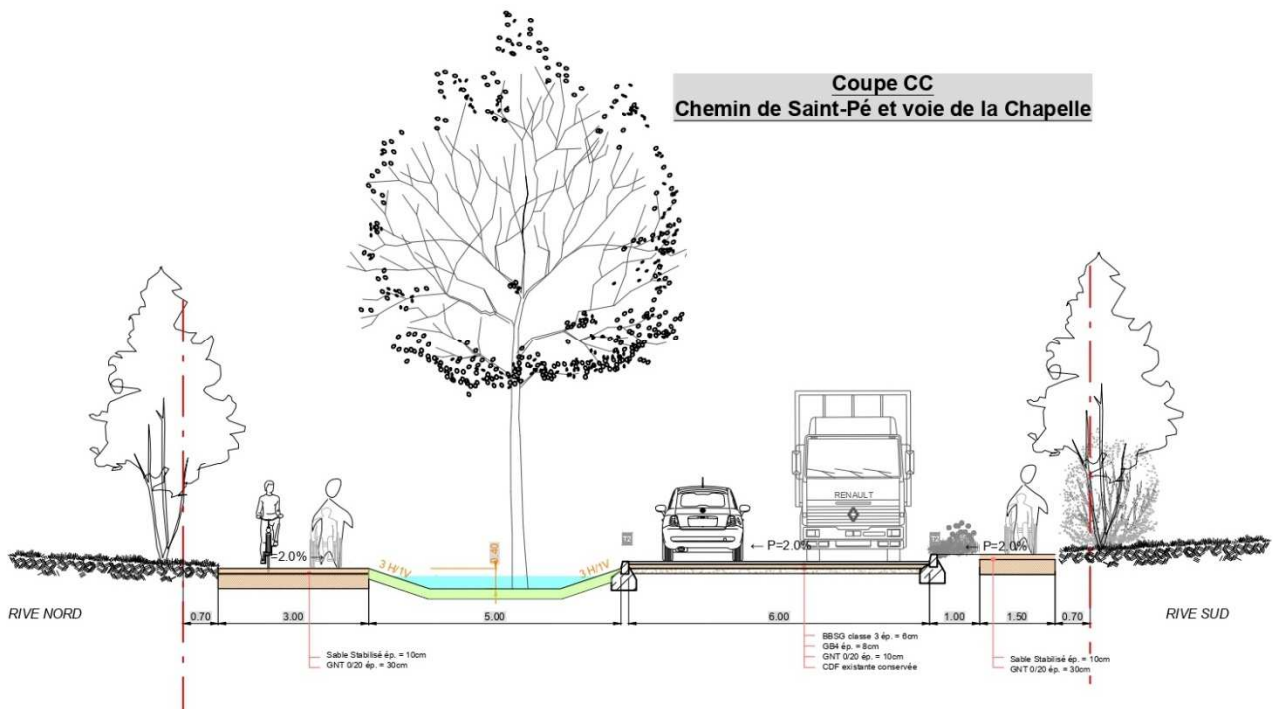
coupe d'illustration des aménagements de voie secondaire
